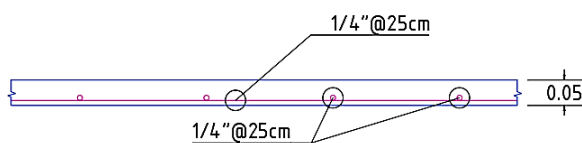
Sección D, E y F de las vigas inclinadas
